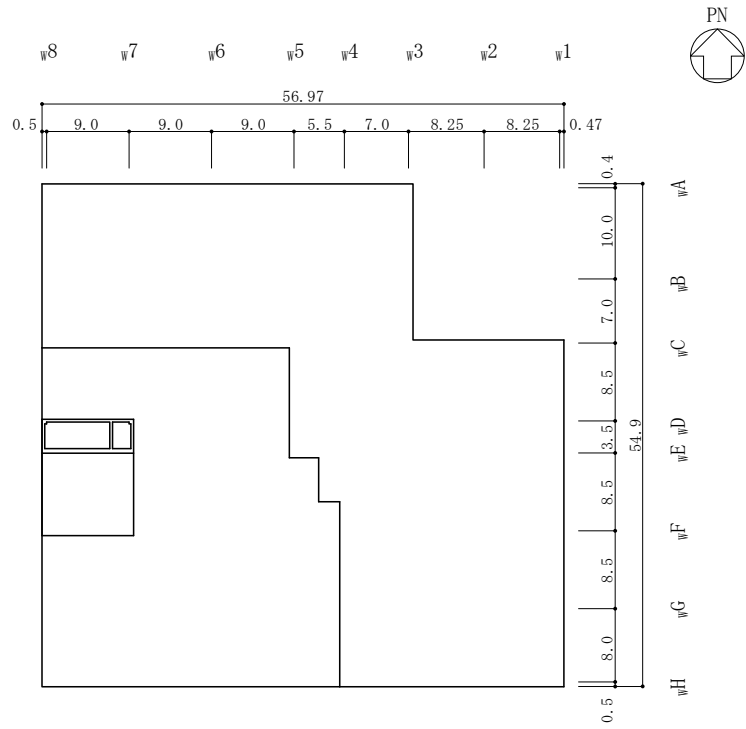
(8) 廃棄物処理建物の概略平面図 (EL 37.5m)
